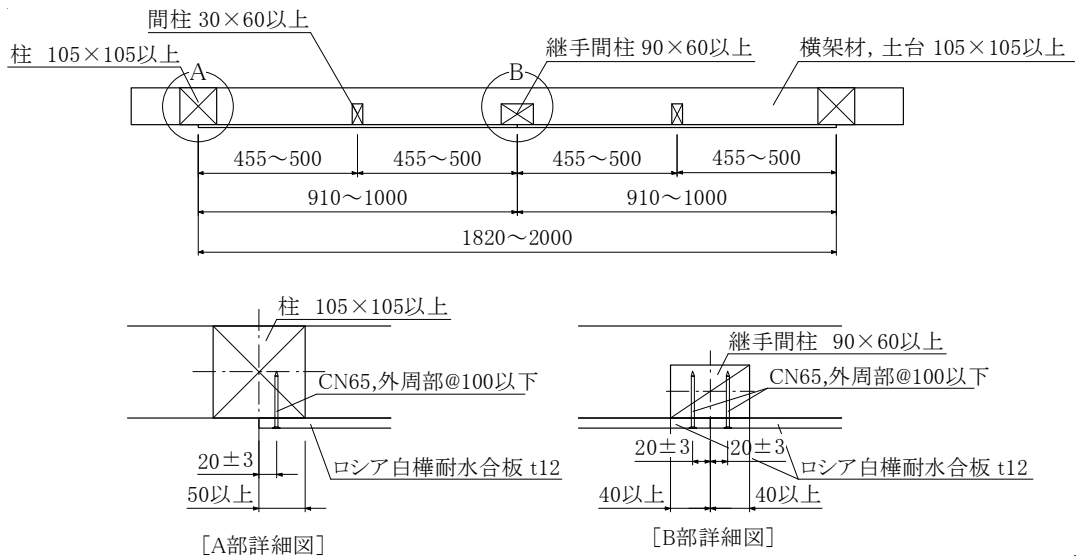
施工図 [水平断面] (寸法単位 : mm)
